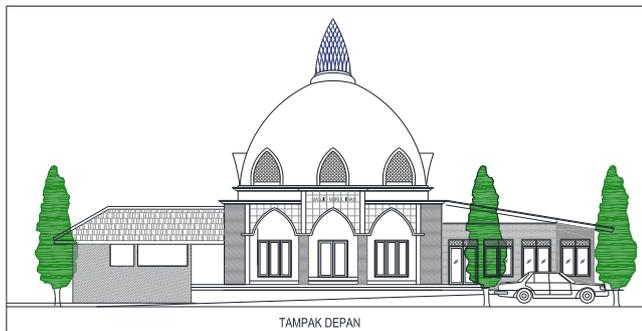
Layout Rekonstruksi Bangunan Masjid
